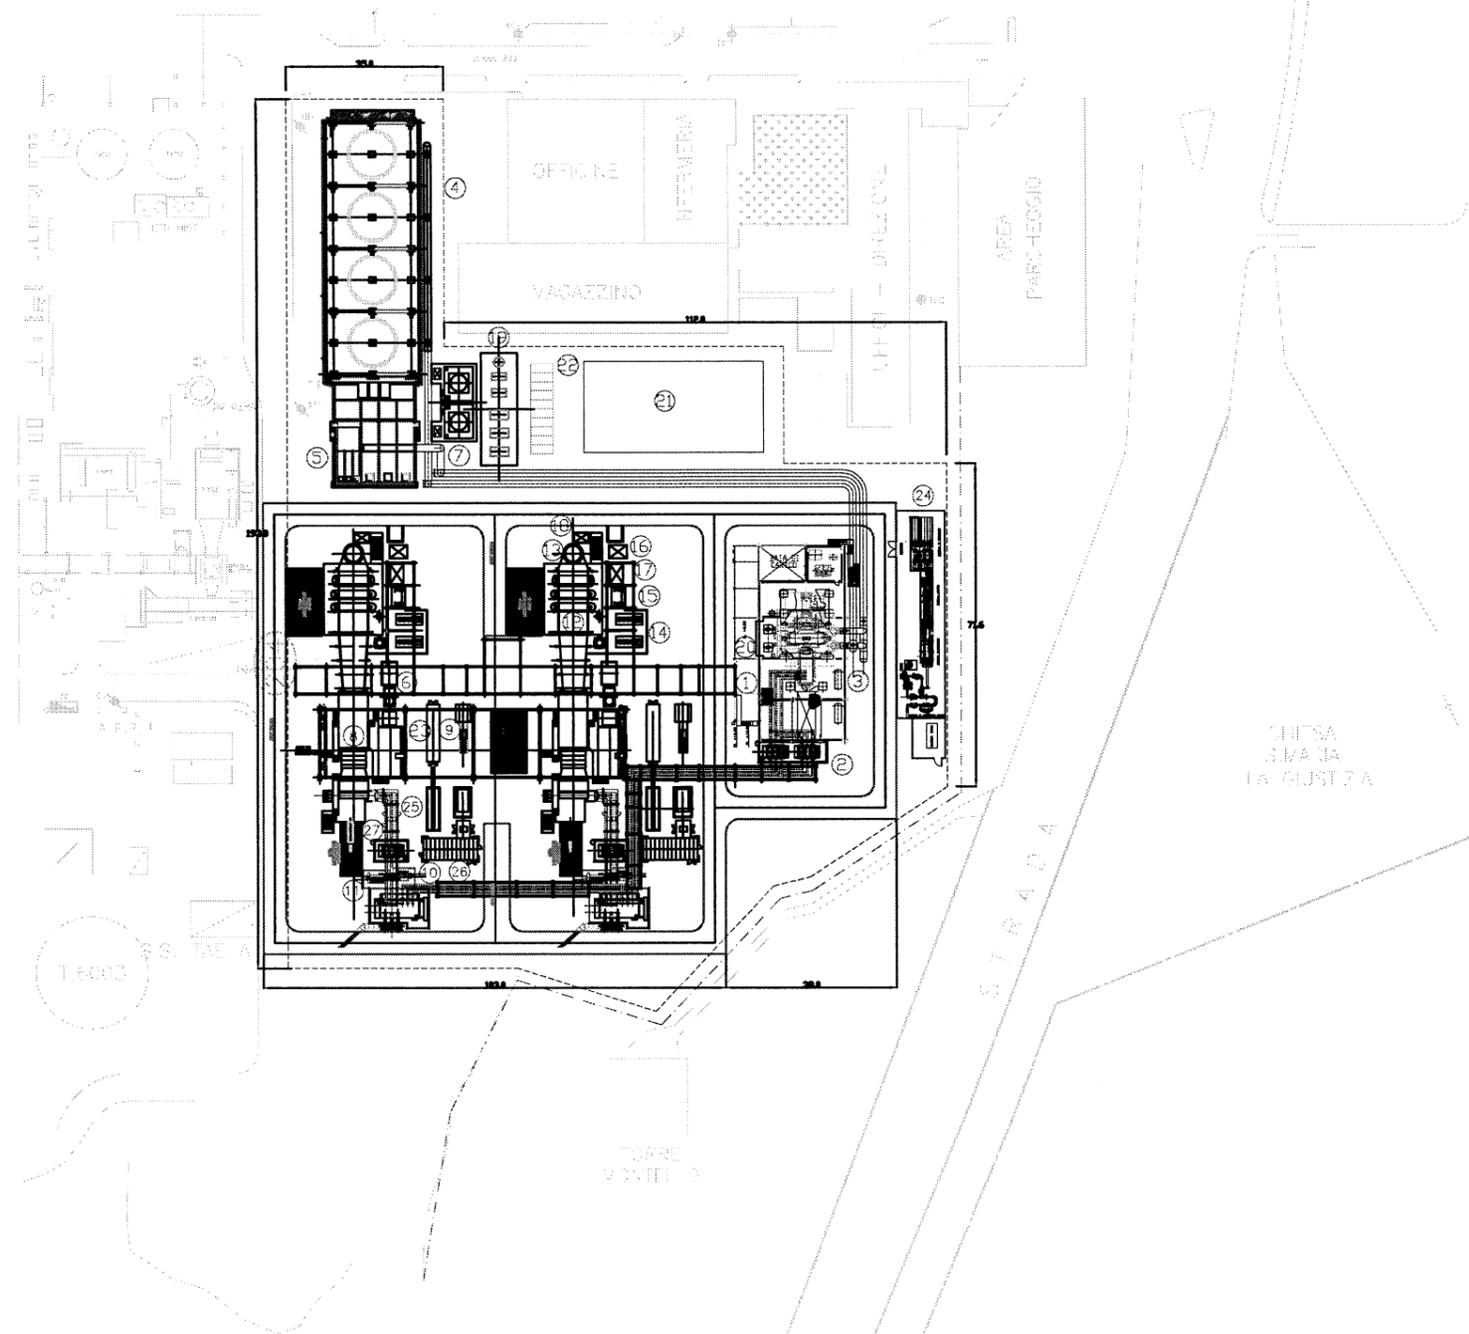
A: Planimetria di Stabilimento con Area di Impianto
